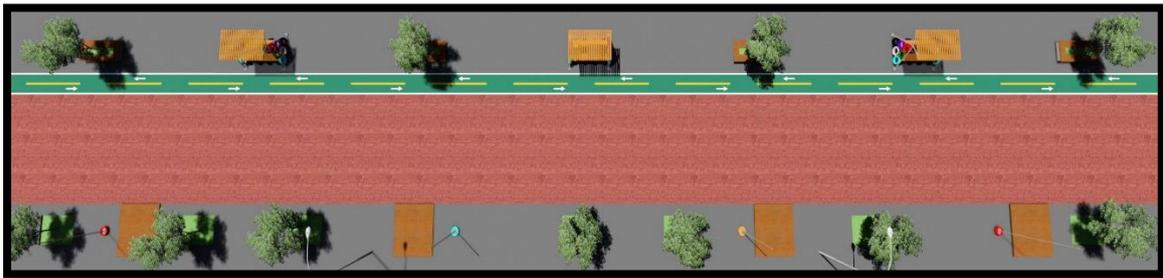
Vista en planta de la Calle 31. Elaboración propia.
